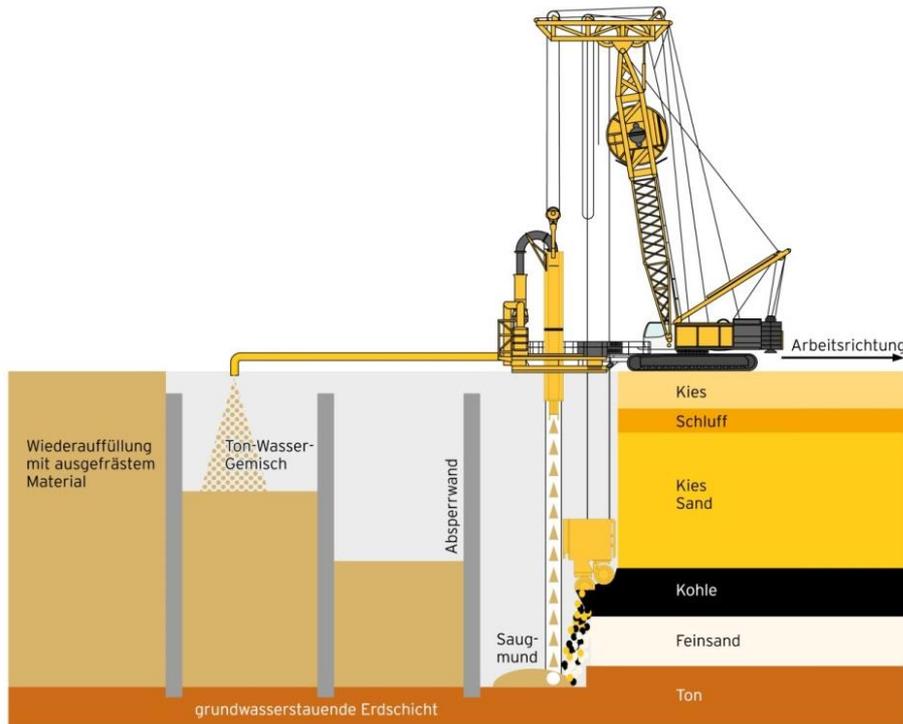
Prinzipskizze zur Errichtung einer Dichtwand im Lockergestein mit dem Schlitzfräsverfahren, Quelle: Arnold & Fisch (2013).
